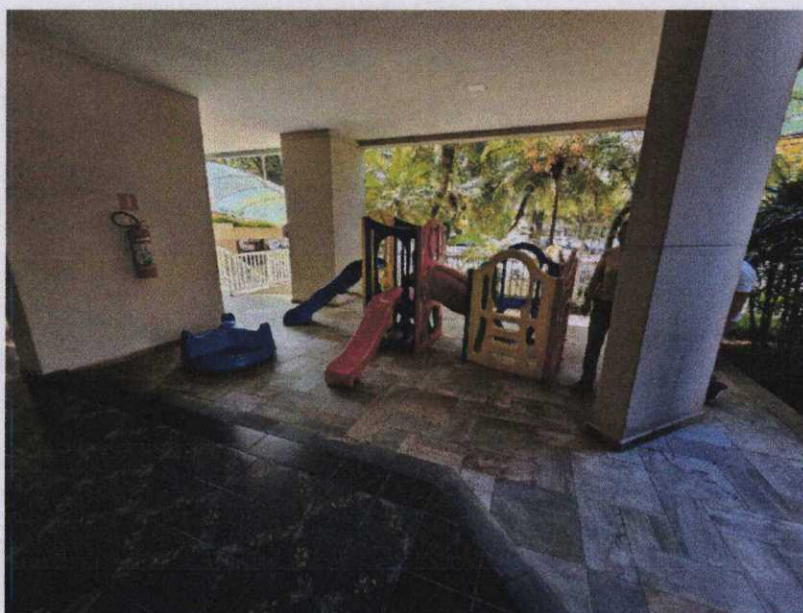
Vista do Playground no pavimento térreo sobre piso de pedra mineira.
